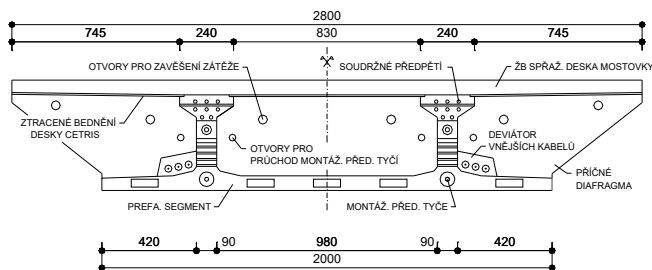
Vedení kabelů II. Fáze, kabelů spojitosti
